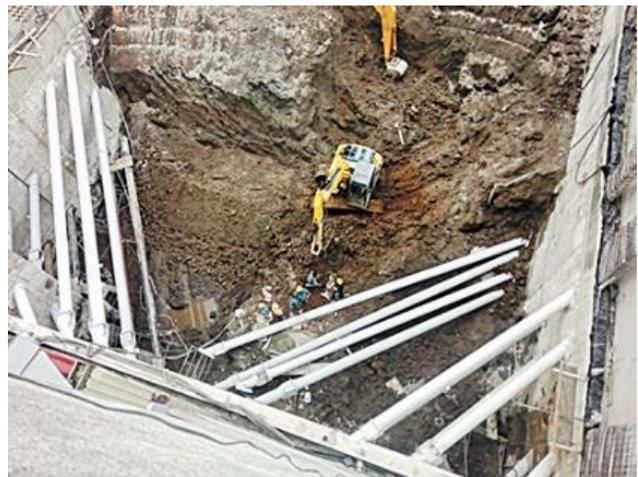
Vista superior del proceso de excavación y apuntalamiento.
